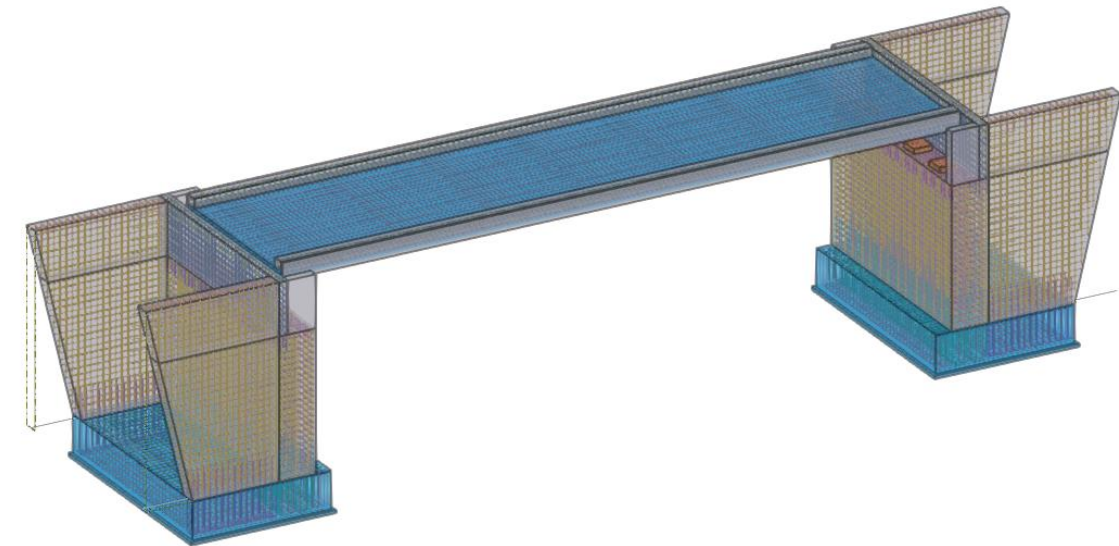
Vista 3D del modelo de las estructuras de hormigón. Elaboración propia con Tekla.
